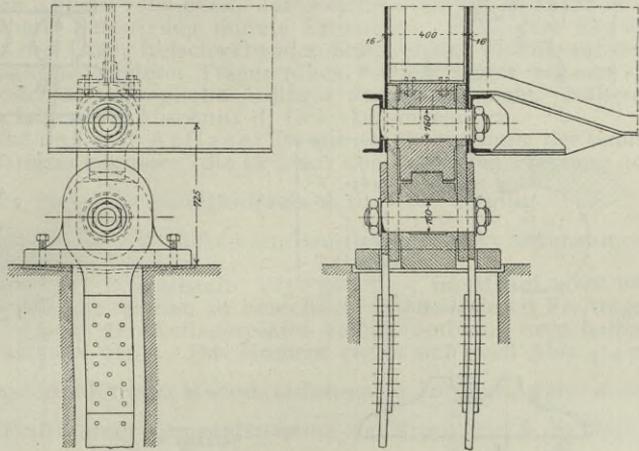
Verankerung der beweglichen Auflager der Mühlenort-Brücke in Lübeck. (Nach Z. V. D. I. 1900 S. 771.)
